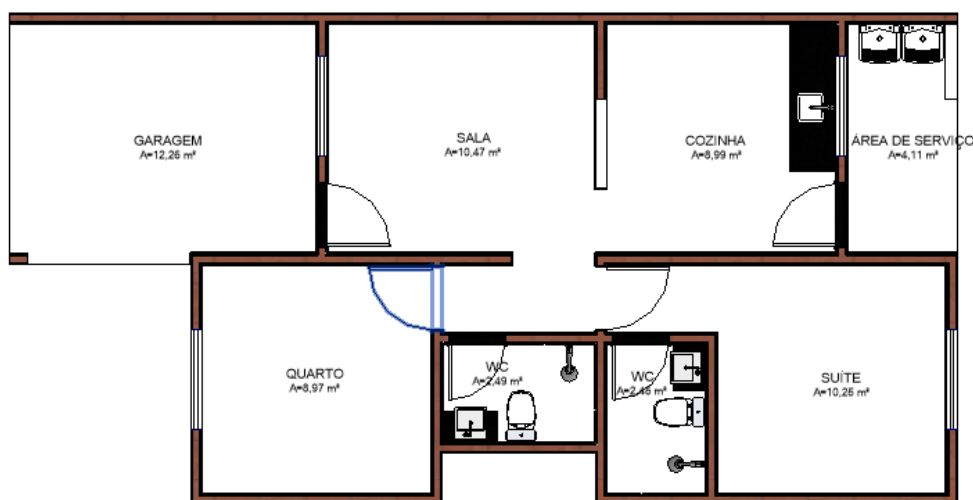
Planta baixa do modelo base ND200. Elaborado pelo autor.
